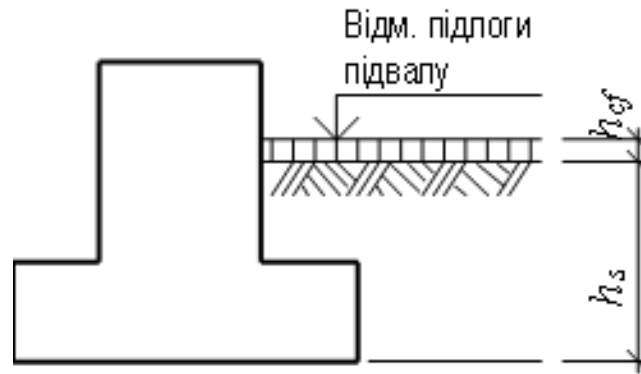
Схема для розрахунку значення d_1 для будівлі з підвалом
